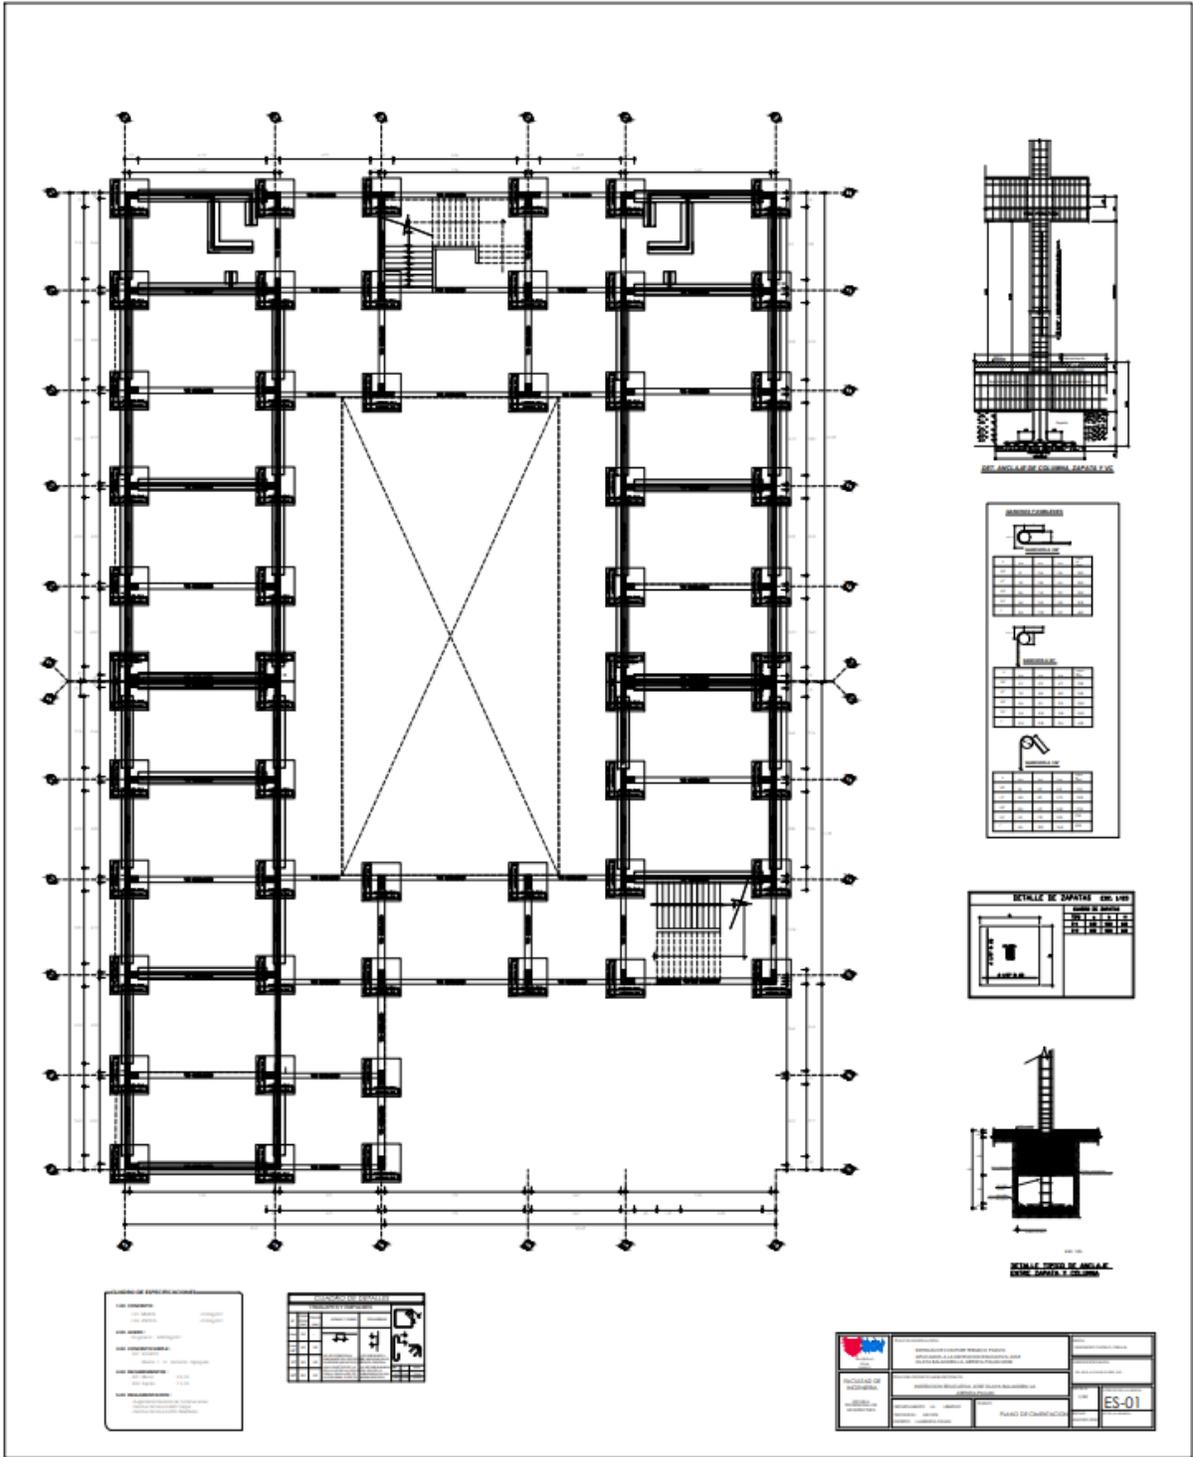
PLANO BÁSICO ESTRUCTURAL CIMENTACIÓN
